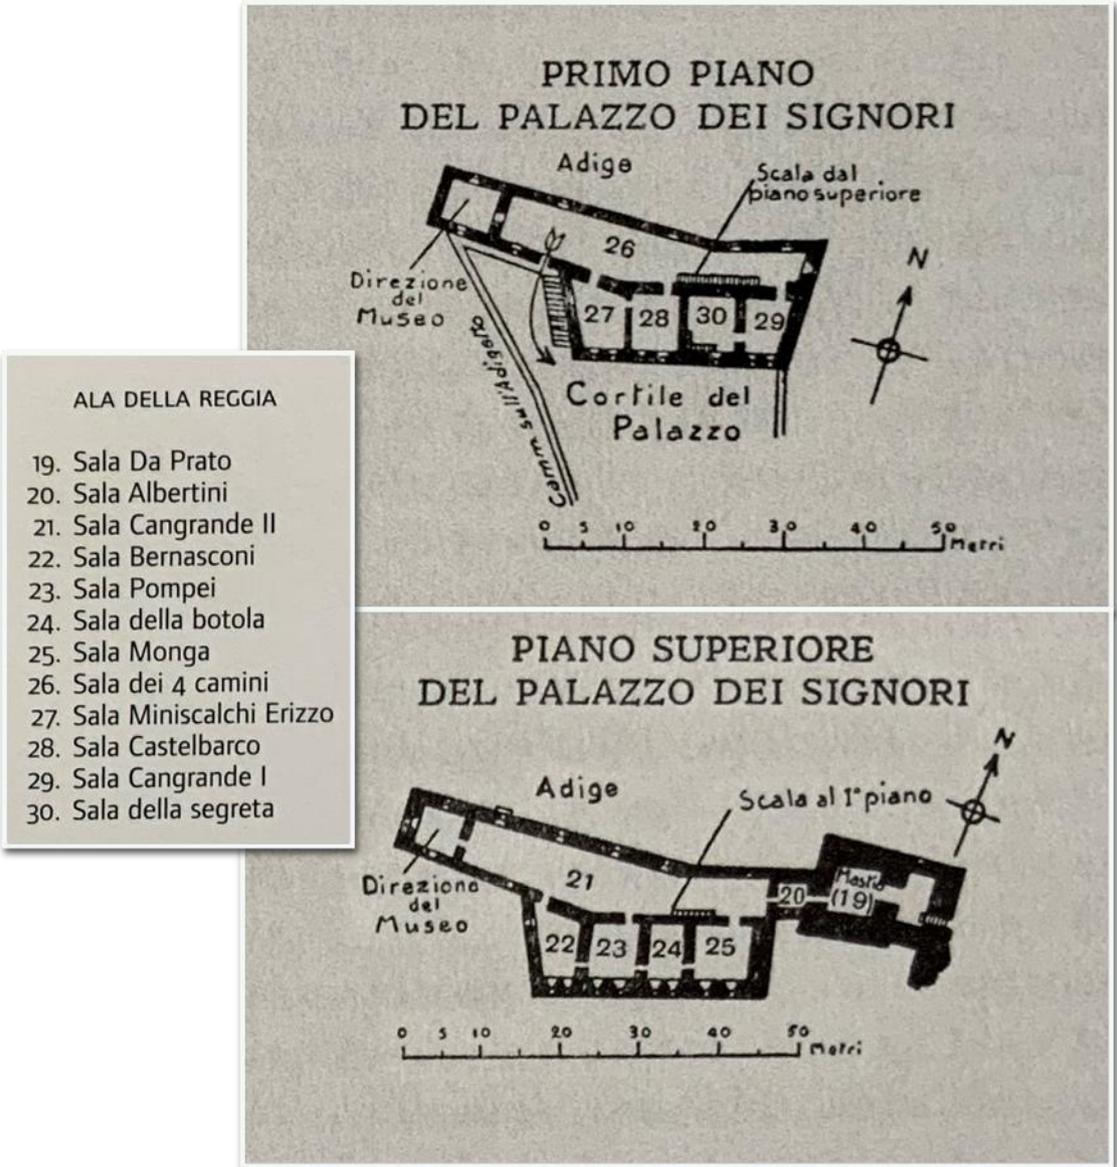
Plantas baixas do primeiro e segundo pavimentos da Ala dela Reggia, em 1954
